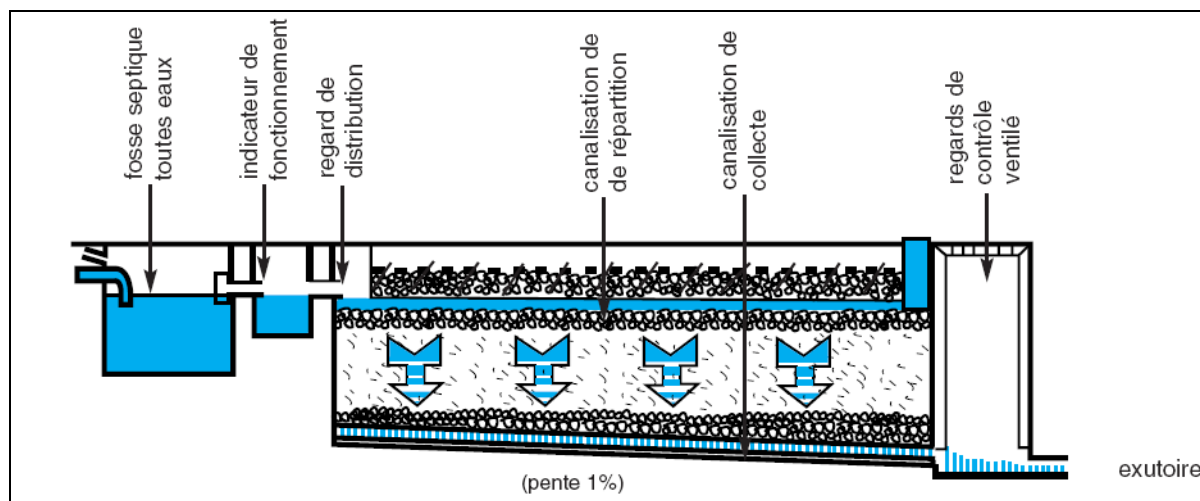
Coupe longitudinale d'un filtre à sable vertical drainé
